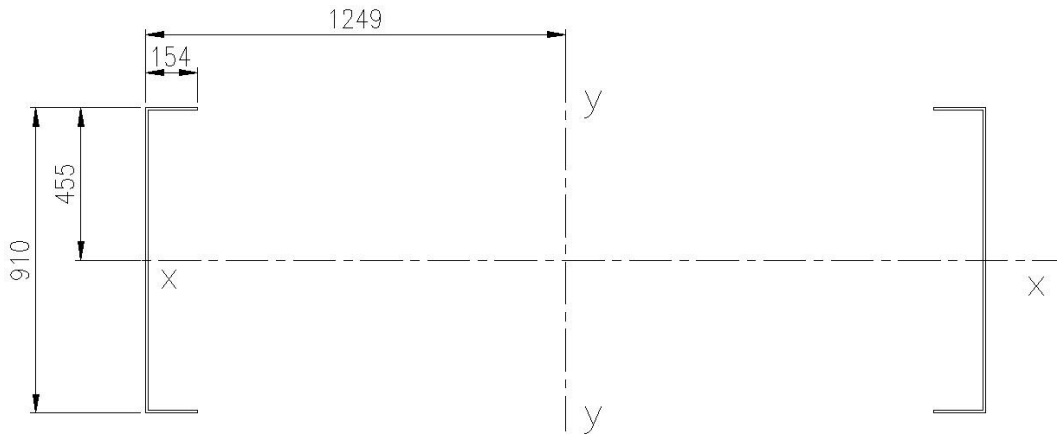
Sección transversal para determinar las propiedades de sección transversal de las piernas del conservador.
